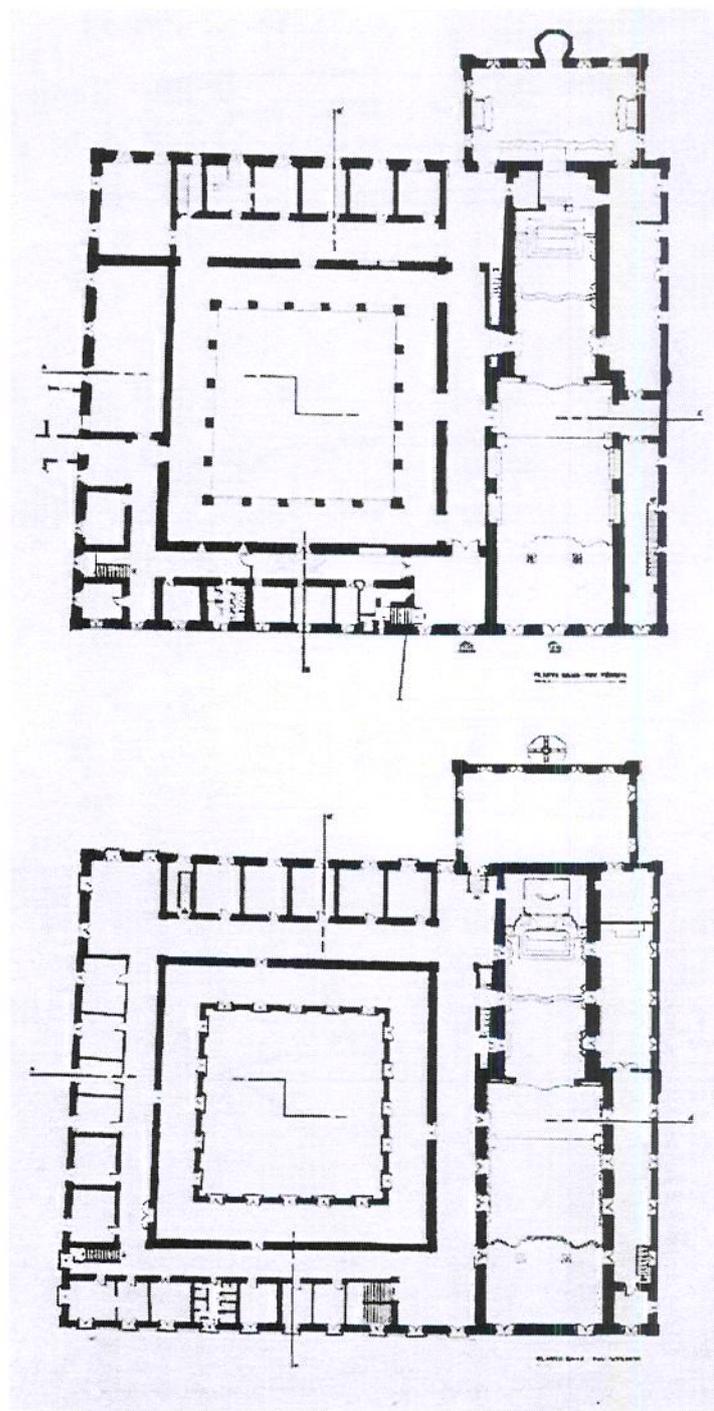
Mosteiro de São Bento de Olinda - Plantas do pavimento térreo e do pavimento superior
